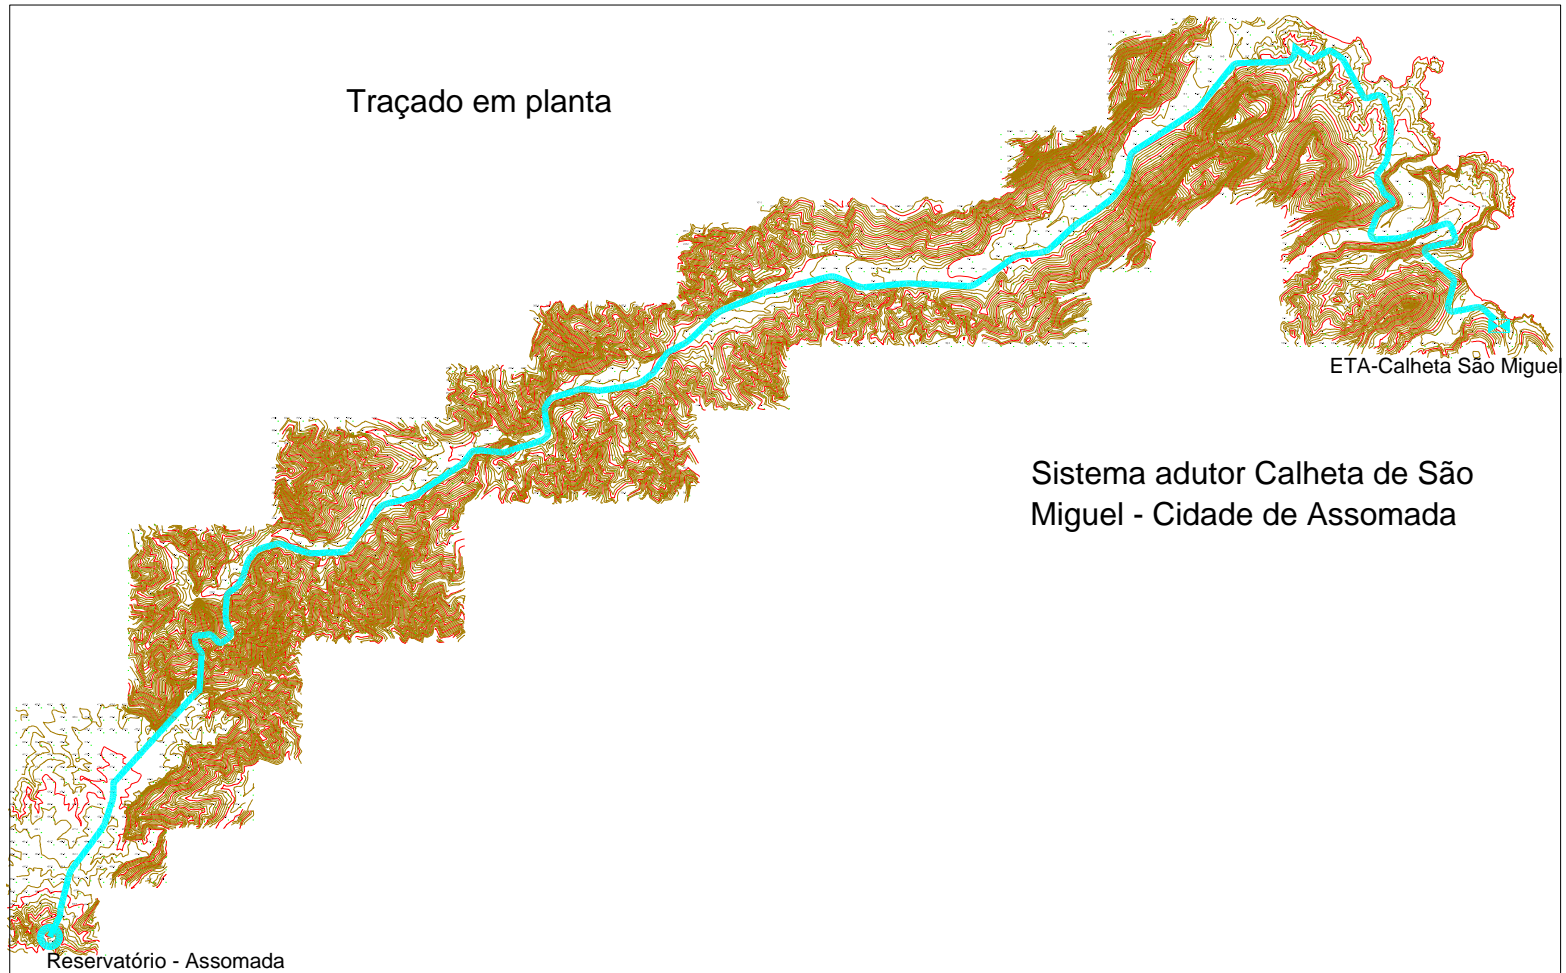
Traçado em planta do sistema adutor Assomada - Calheta São Miguel
